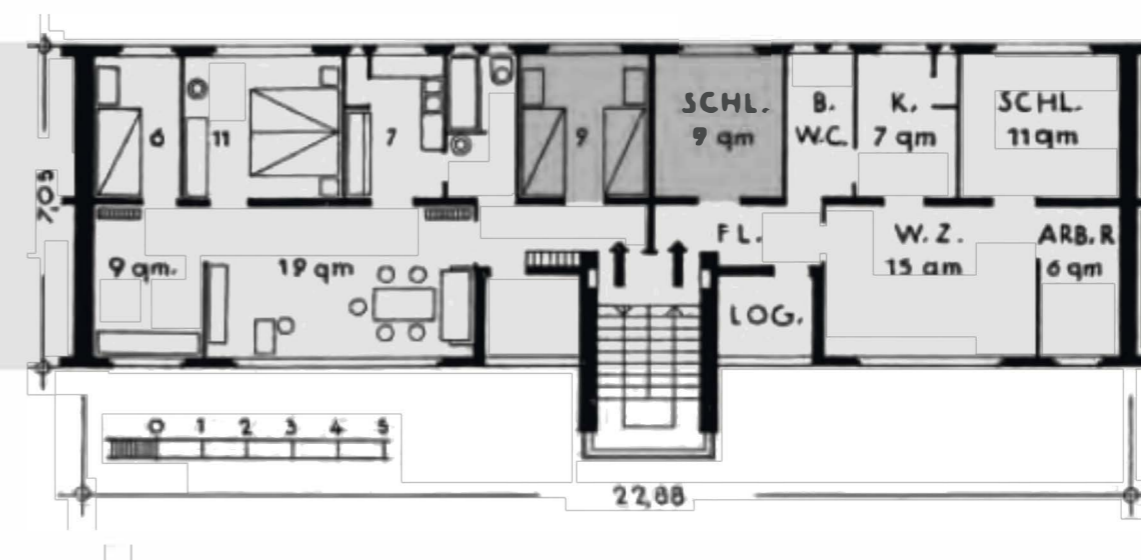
O. Haesler, Edificio de viviendas en la Siedlung Dammerstock
